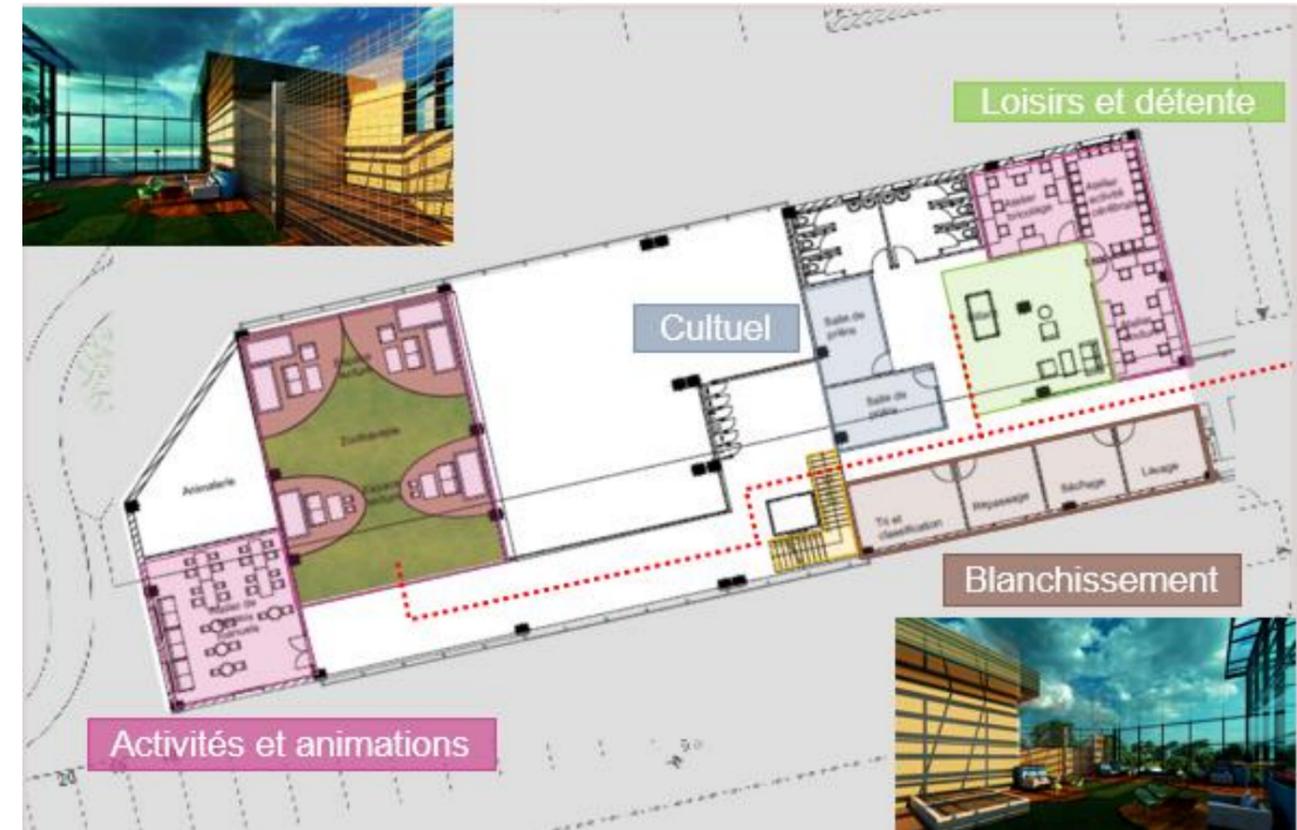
Plan du 1^{er} étage – Bâtiment commun
